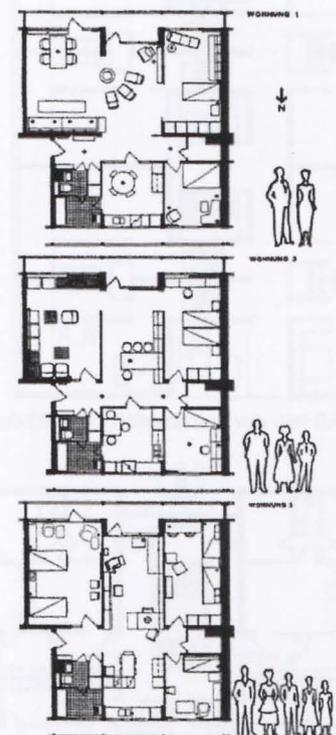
1957 Jaenecke und Samuelson, Berlin Interbau 57, 10-geschossiges Wohnhaus
